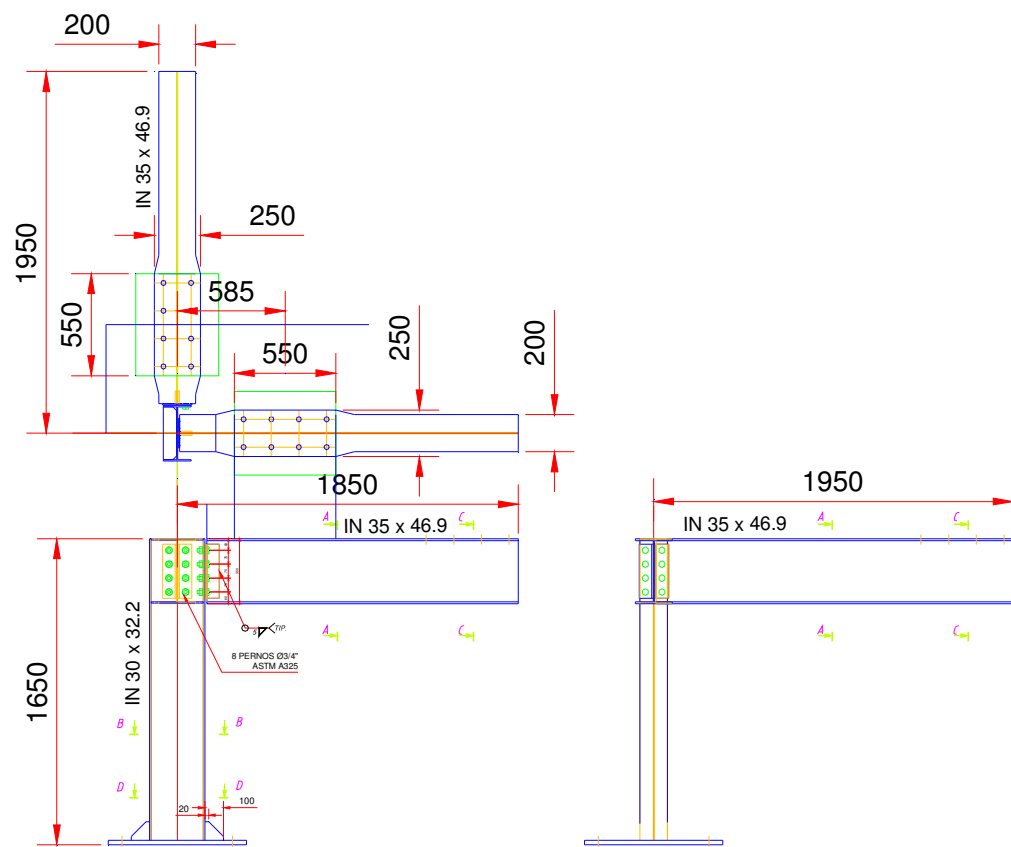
Probeta Viga-Columna Ensayo Nro 02
